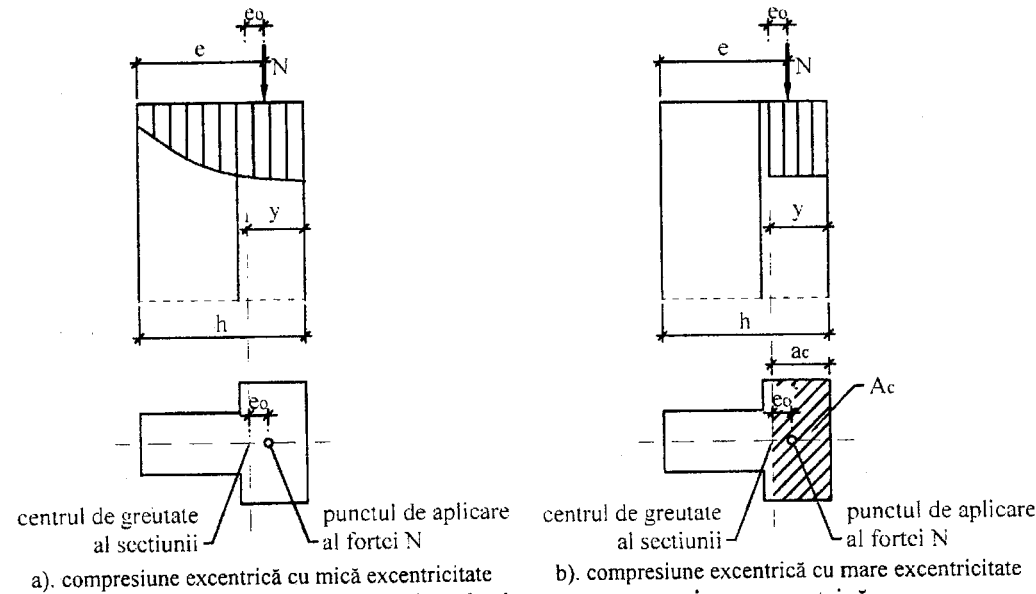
Schema de calcul pentru compresiune excentrică
